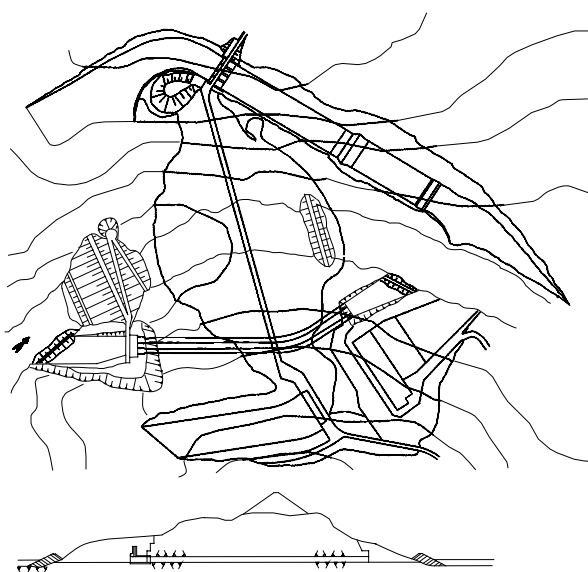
Desvio do rio através de túneis escavados em ombreira – planta e perfil.
